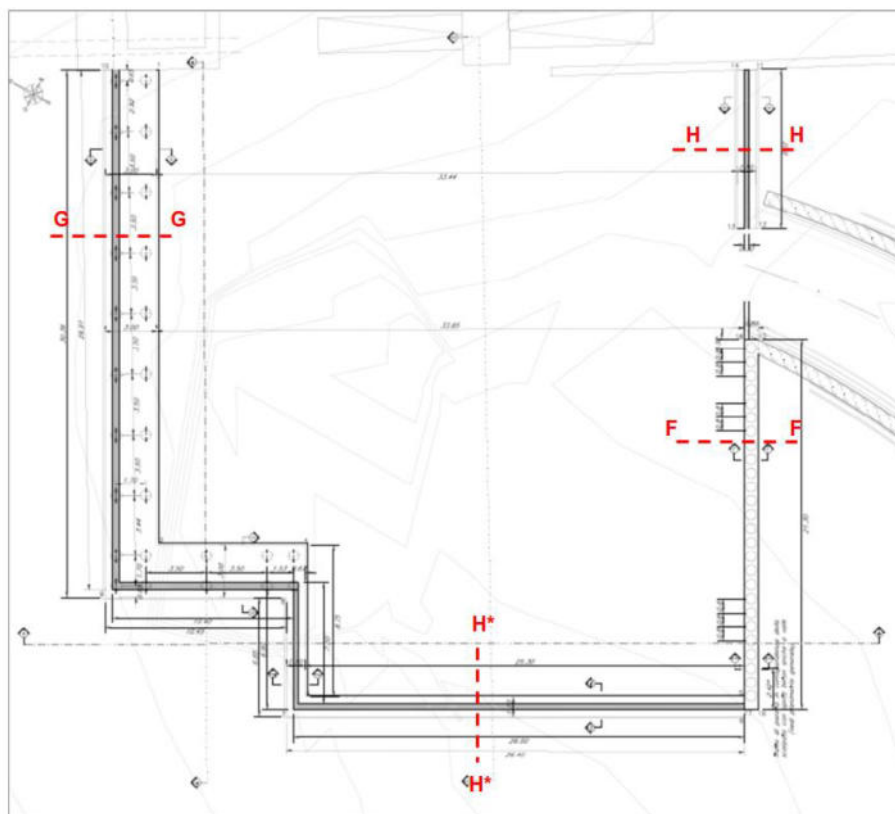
Fondazioni muro di sostegno RI053 – Come da PE
